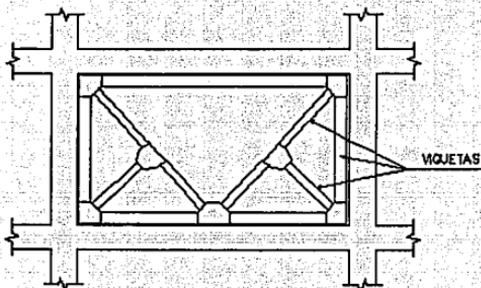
Alternativa de contraventeo con perfiles metálicos.
